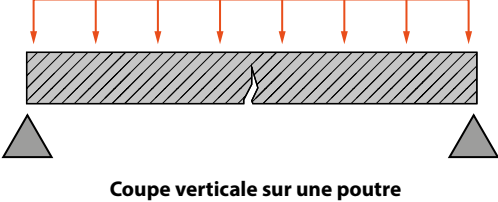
Exemple d'analyse des fissures présentes en façade des avoisinants.
